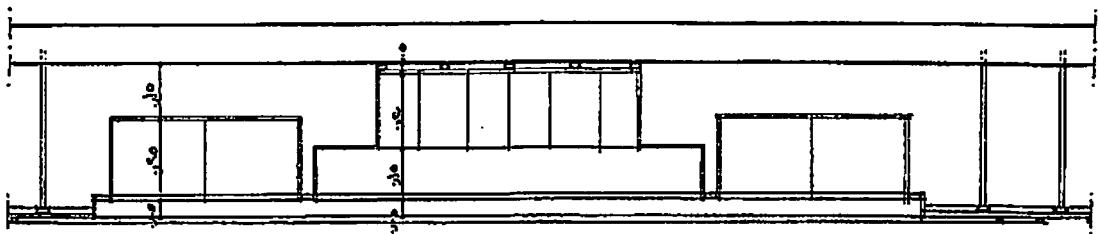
مسقط أفقي سقف خشبي لمحل سياحي أمام ميدان أبو الهول بالهرم
